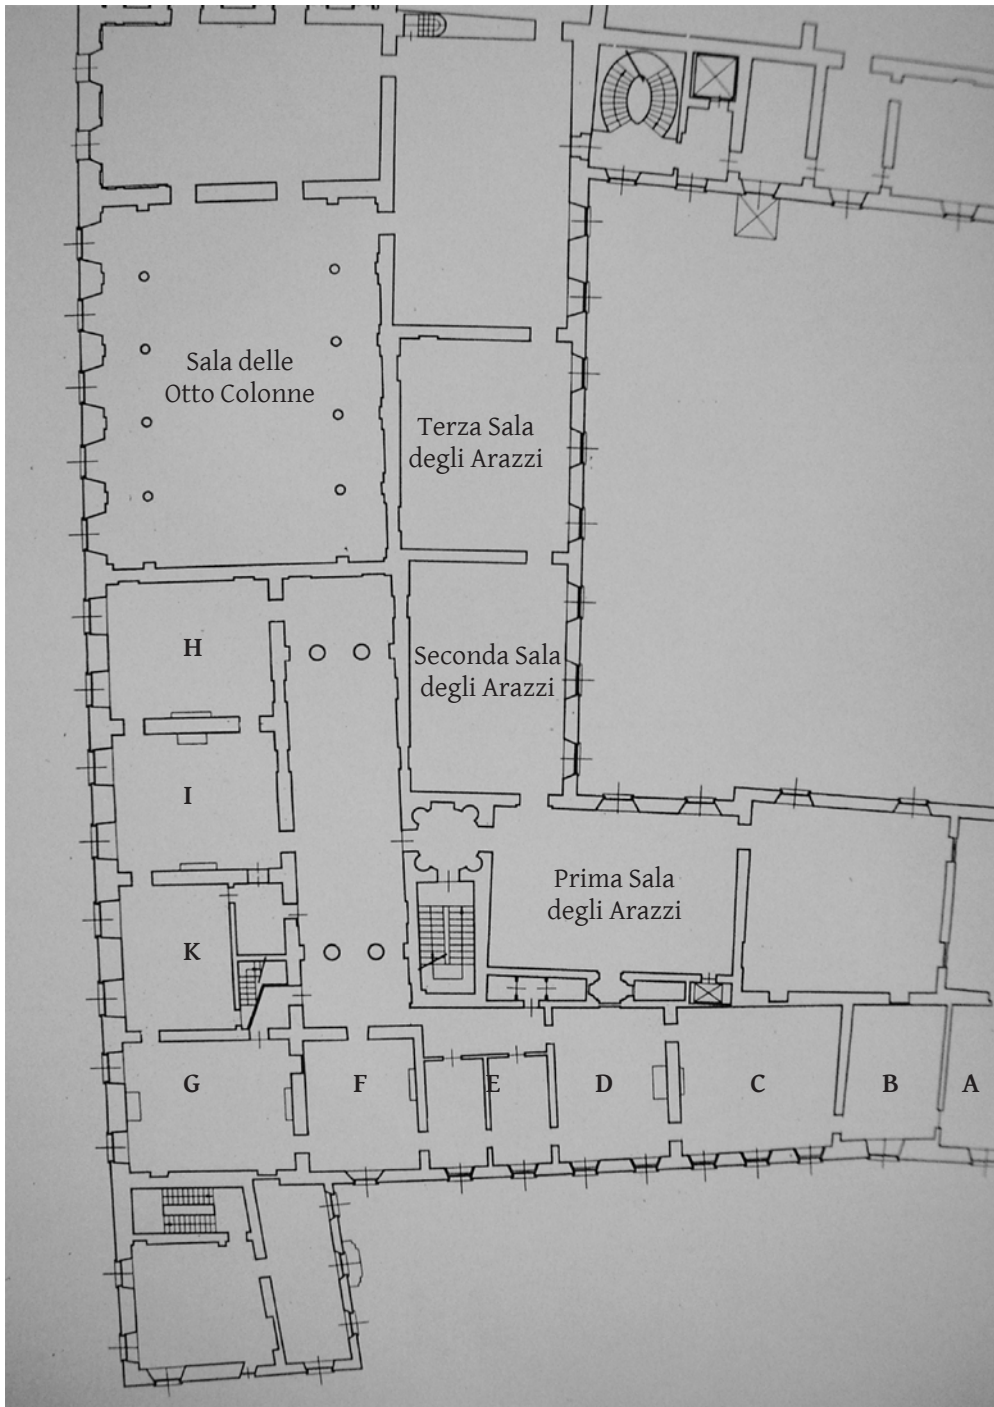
L'attuale pianta dell'Appartamento di Riserva.
